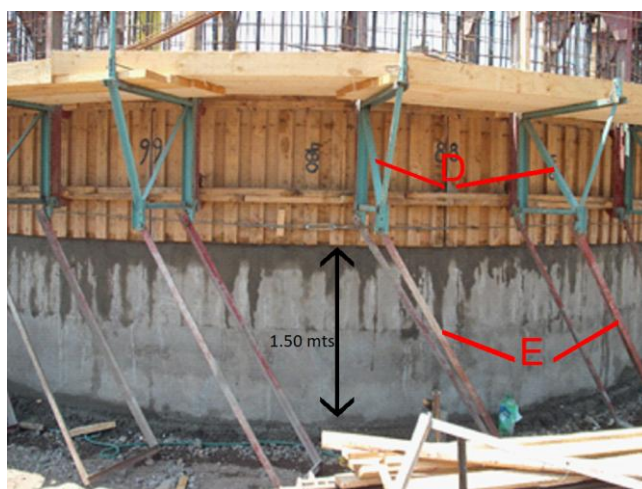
Plataforma de trabajo interior con adición de Viga Metálica
